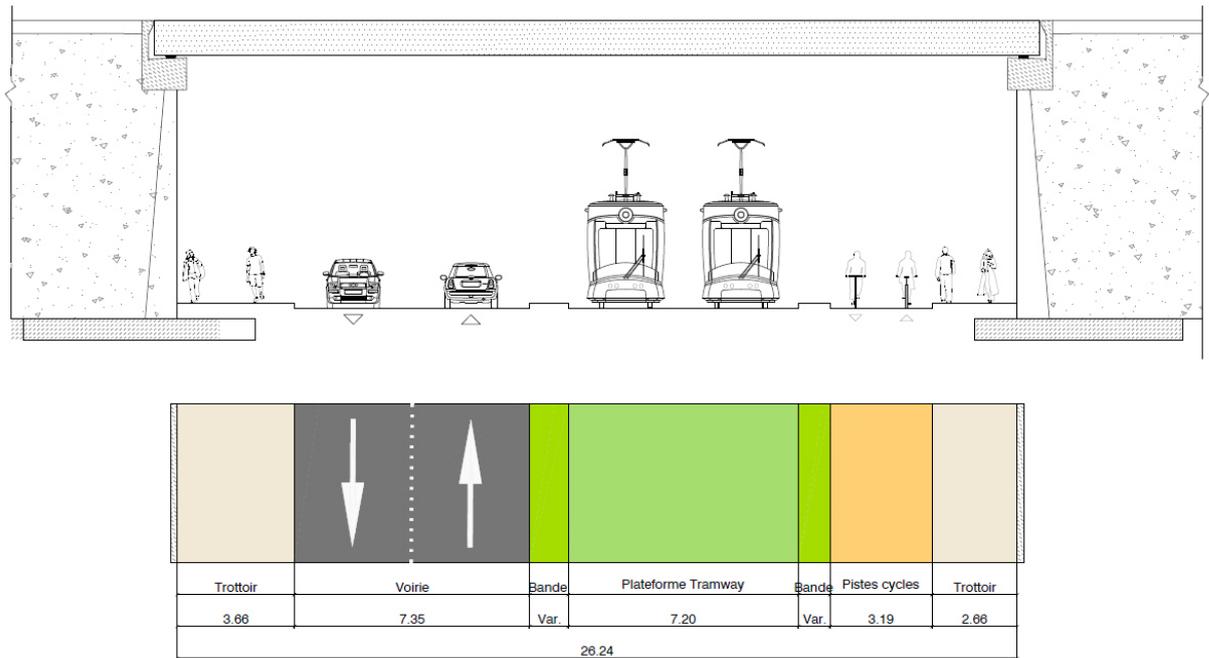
Coupe au droit de l'ouvrage avec ouverture souhaitée à 26.24 m, largeur de la dalle tramway, largeur des chaussées encadrantes, protection prévue (trottoir, piste cyclable) – Etudes préliminaires TNS2
